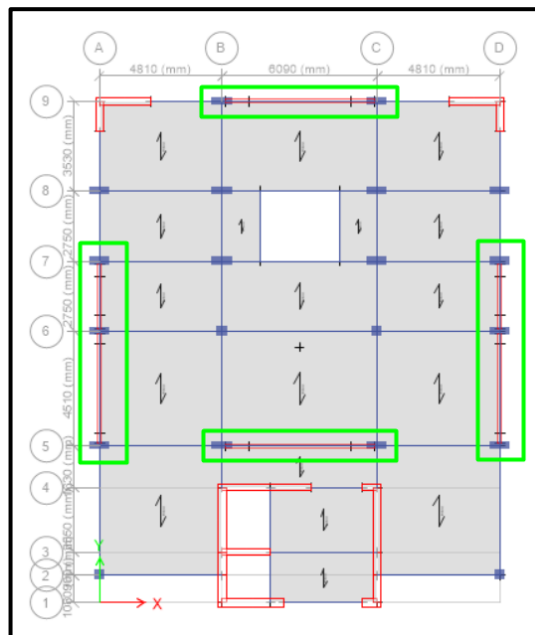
Modelamiento edificación multifamiliar con SLB, vista en planta.
